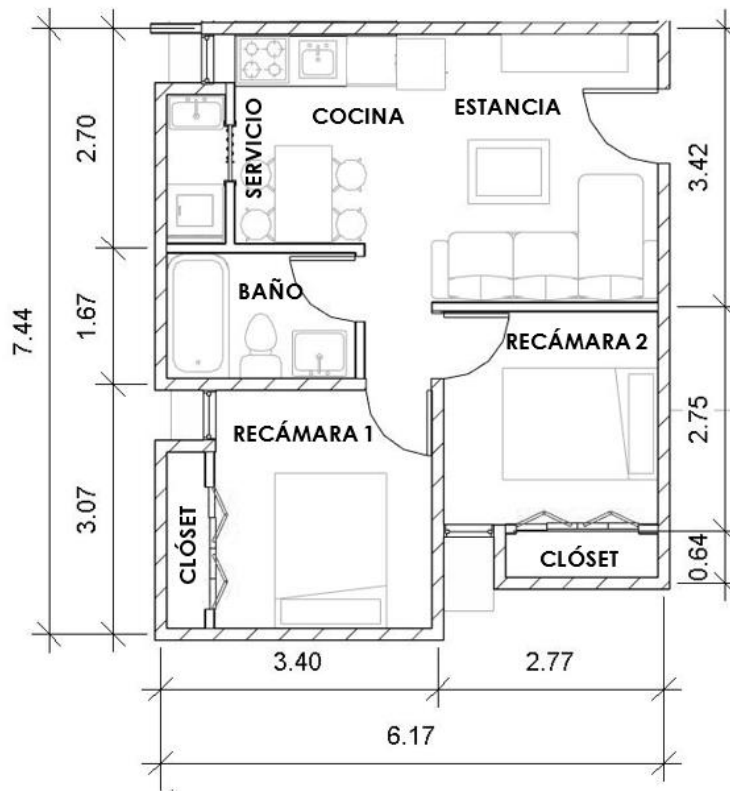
Planta arquitectónica de Vivienda tipo “C”
